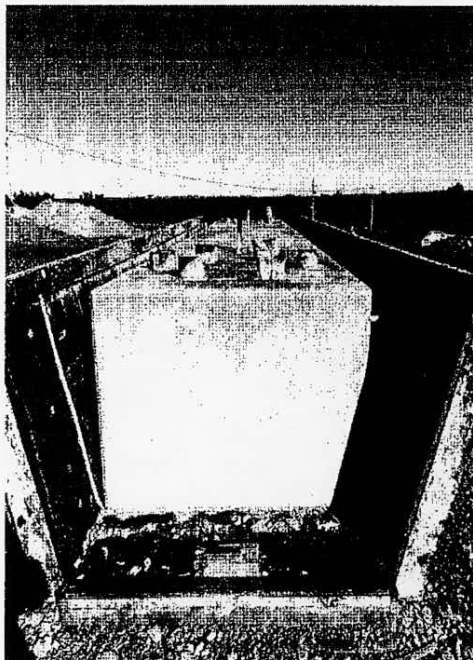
, 16 y 17 – Izaje de vigas prefabricadas postensadas
